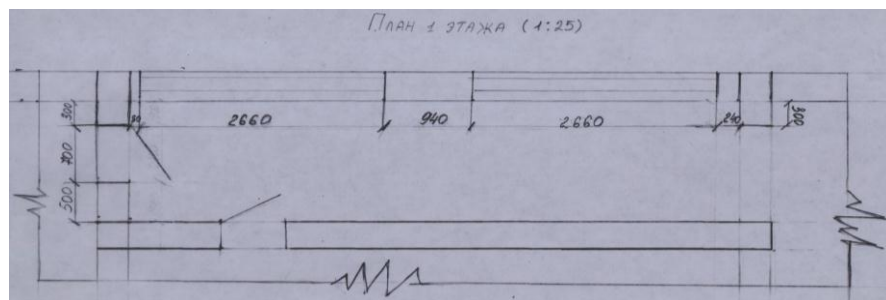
План подсобного помещения расположенного на первом этаже
